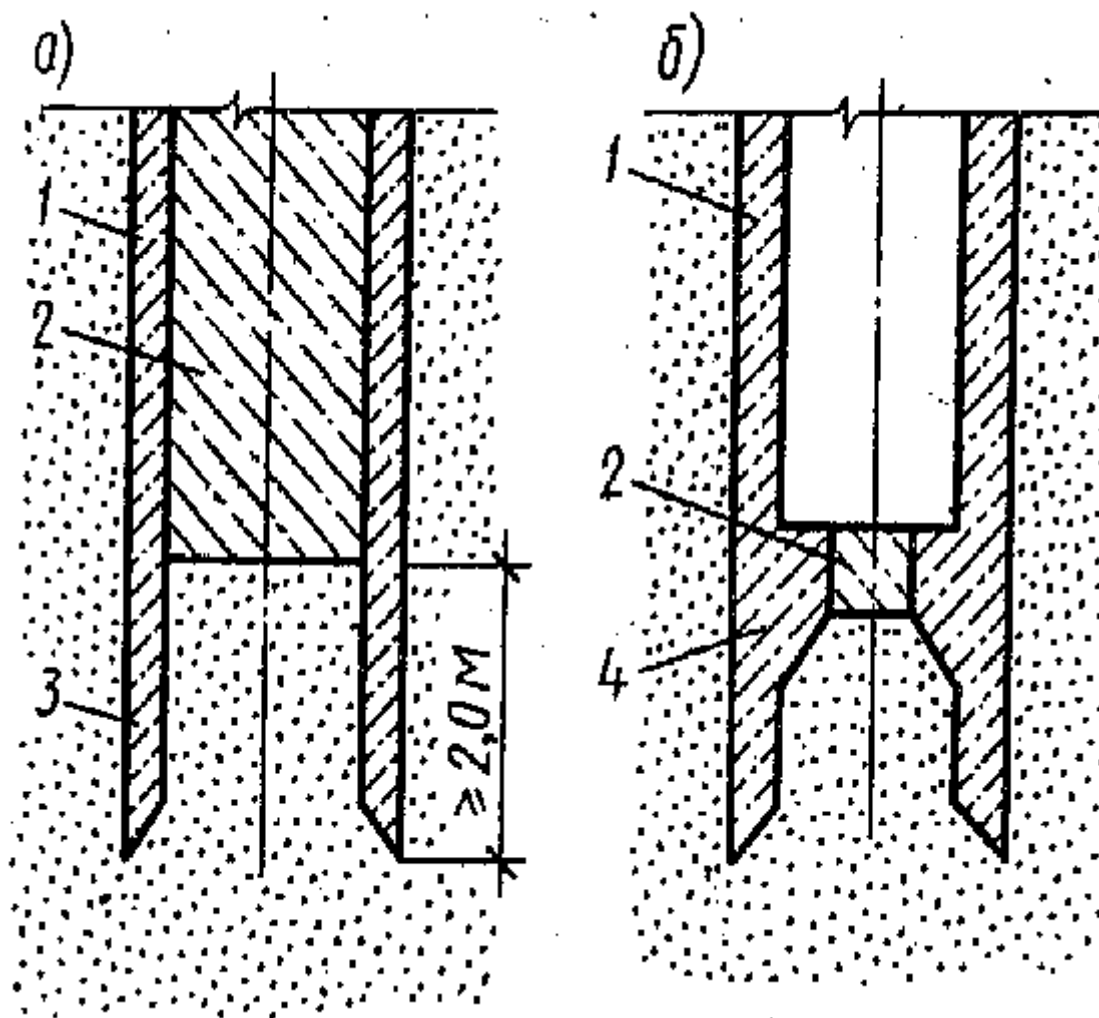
а, б. Конструкция сборных железобетонных оболочек:
